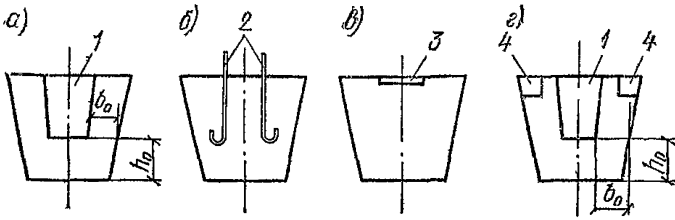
Конструкция фундаментов в вытрамбованных котлованах
